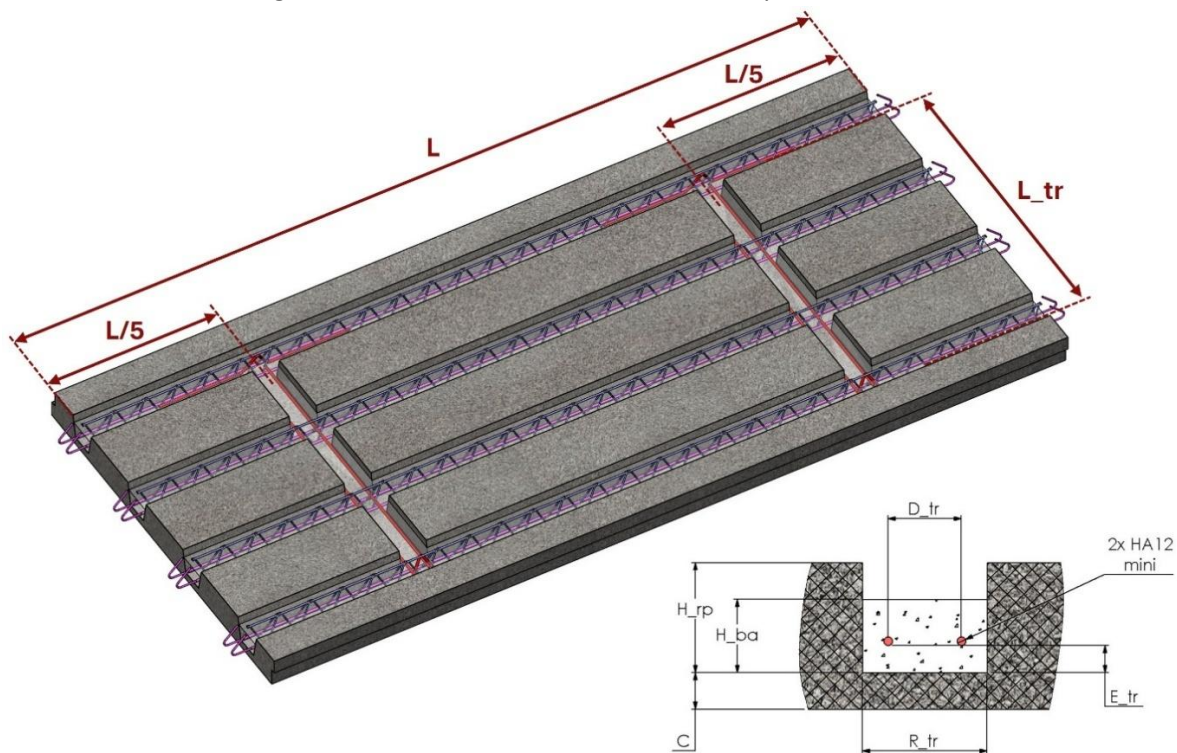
Cotation type d'une prédalle DS1 avec raidisseurs transversaux – 4 poutrelles
